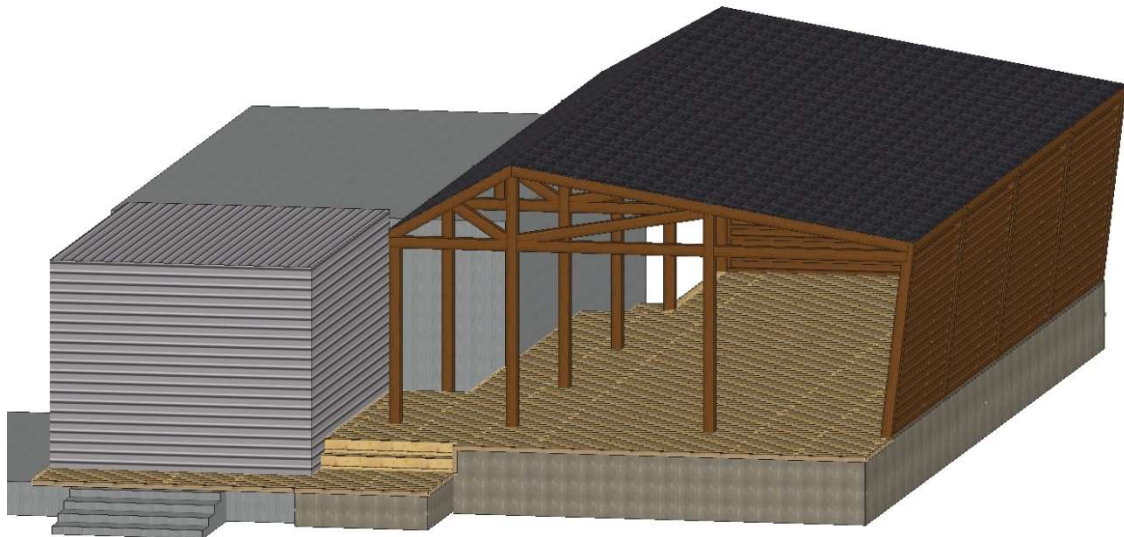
Sexta propuesta de estructura. Imagen de Cadwork.
